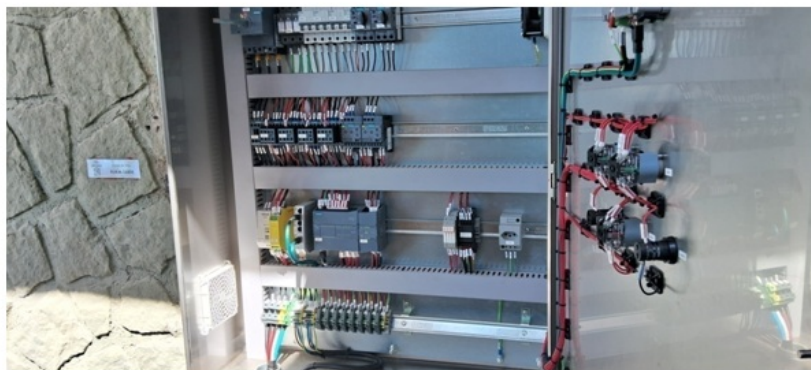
Vista interna do painel eletrônico de controle do sistema de gradeamento em bom estado de conservação.
